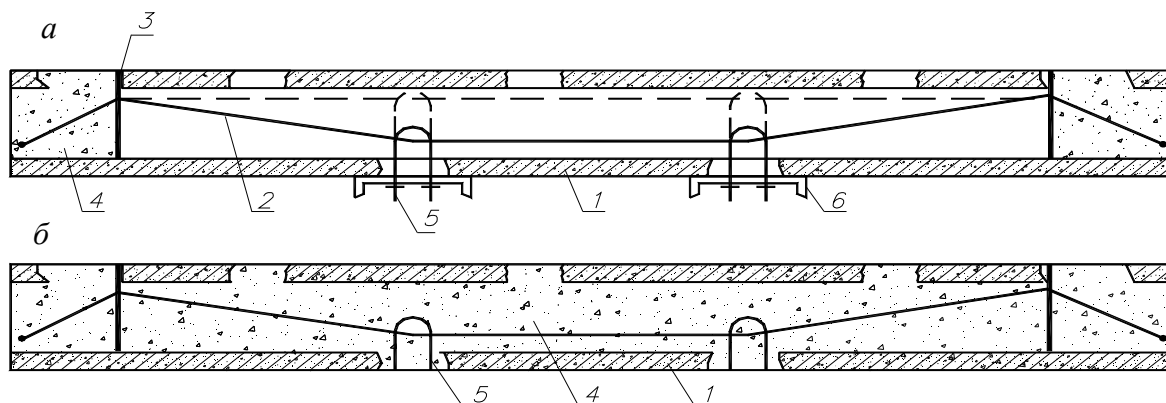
Усиление сборных многопустотных плит предварительно напряженной арматурой: *а* – плиты в момент предварительного напряжения арматуры; *б* – усиленная плита, 1 – усиливаемая плита, 2 – дополнительная арматура, 3 – временная ограничительная пластина, 4 – бетон, 5 – натяжной болт, 6 – опалубка
